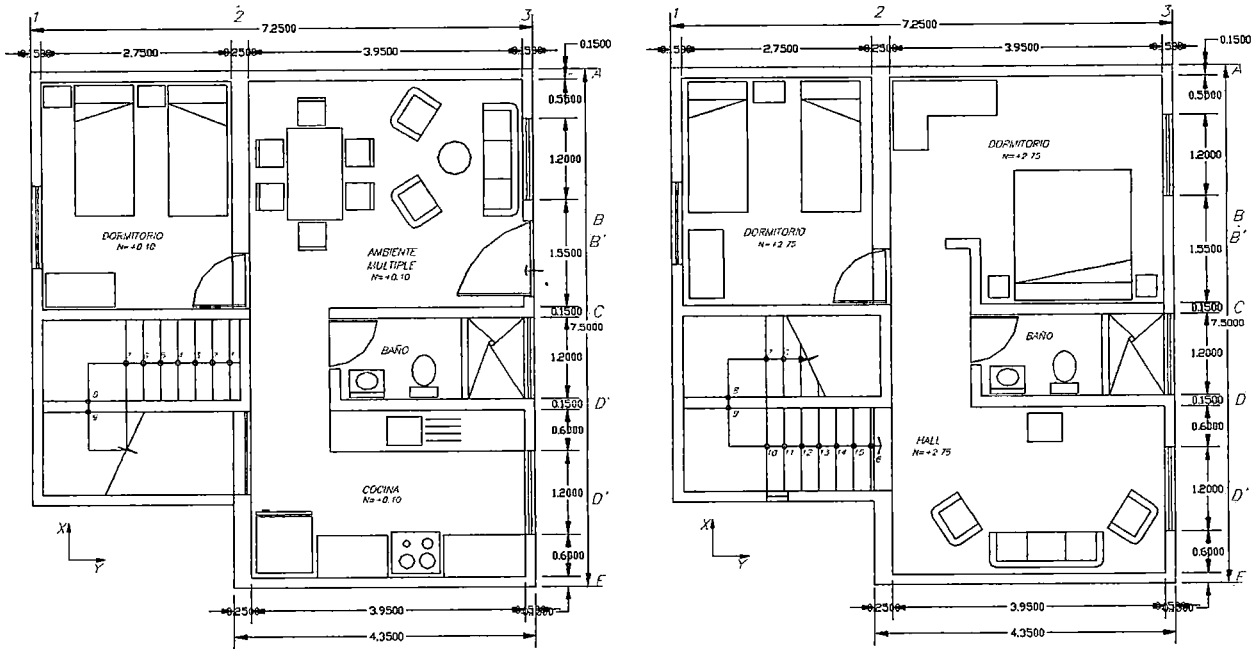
Planta 1er y 2do nivel de la Vivienda
